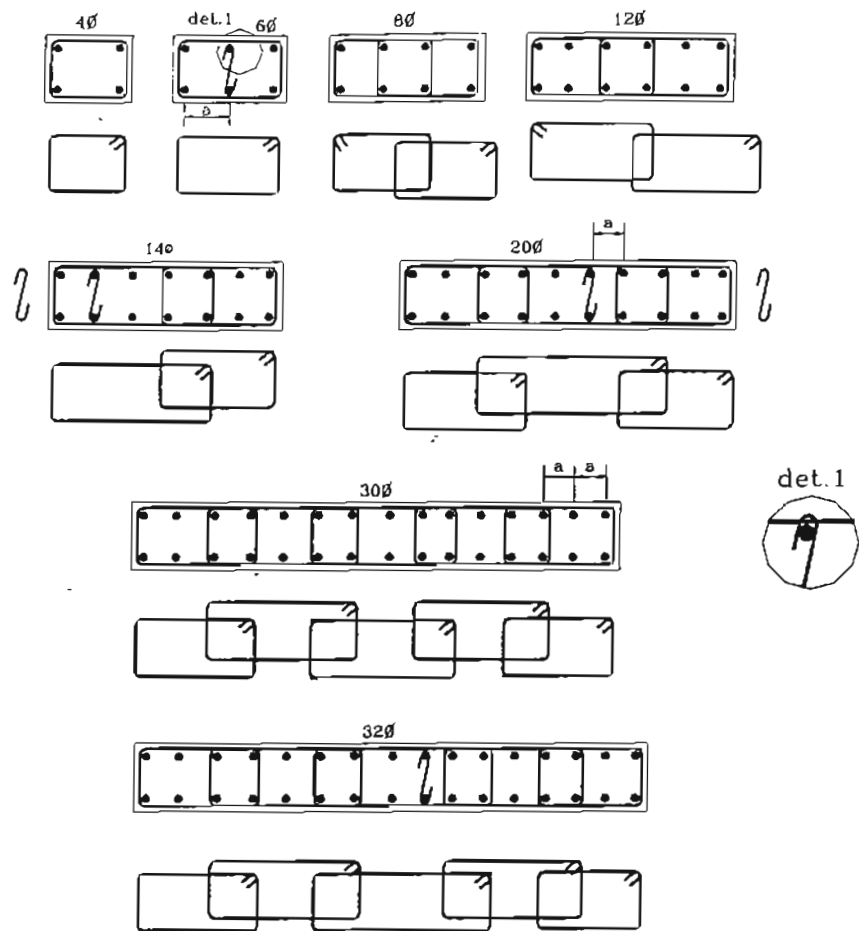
Arranjos de estribos para pilares retangulares
